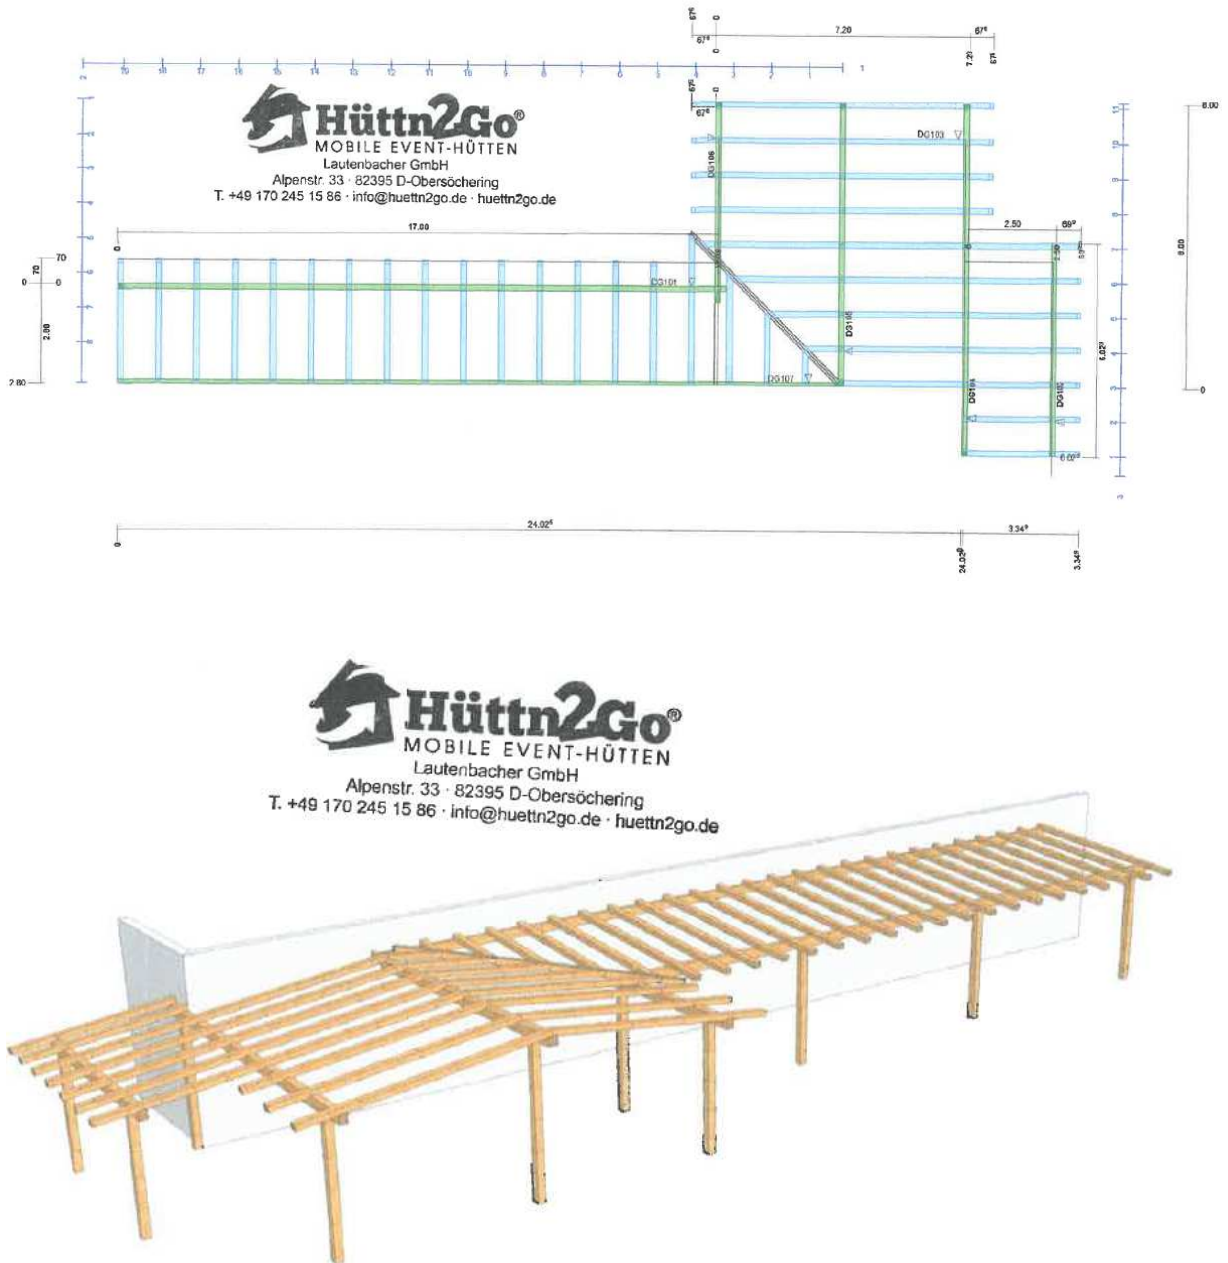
Grundriss und 3D- Ansicht, geplante Überdachung, Planung SEMA GmbH, 09.12.2021
